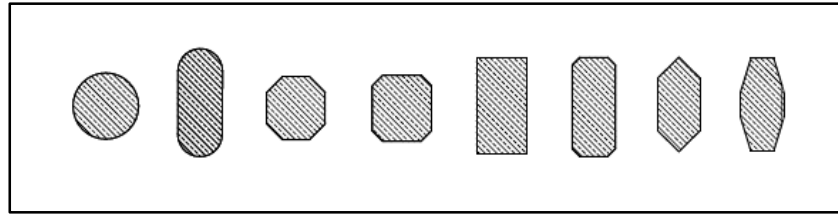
tipos de sección transversal de columnas en puentes.
